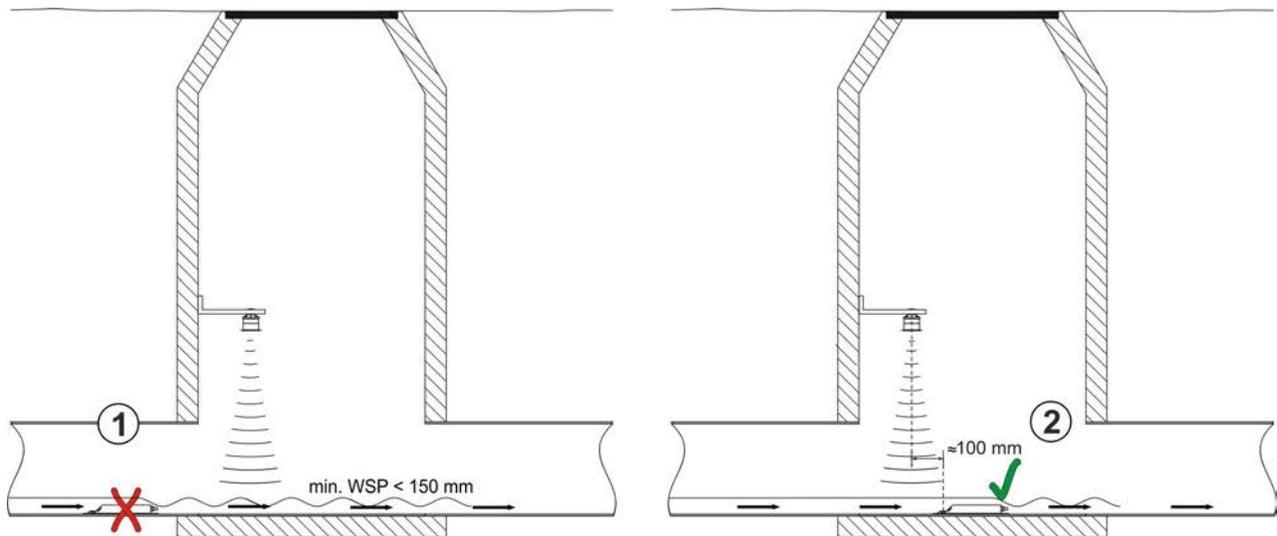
Fehler durch Einbauten oder Versperrungen (Draufsicht) (Prinzip)
